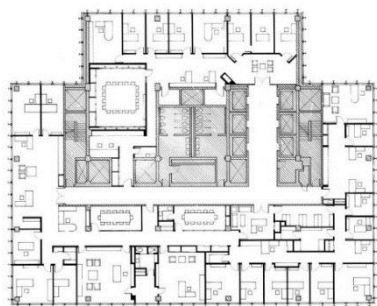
86 ผังพื้นที่ Typical อาคาร Seagram Building
